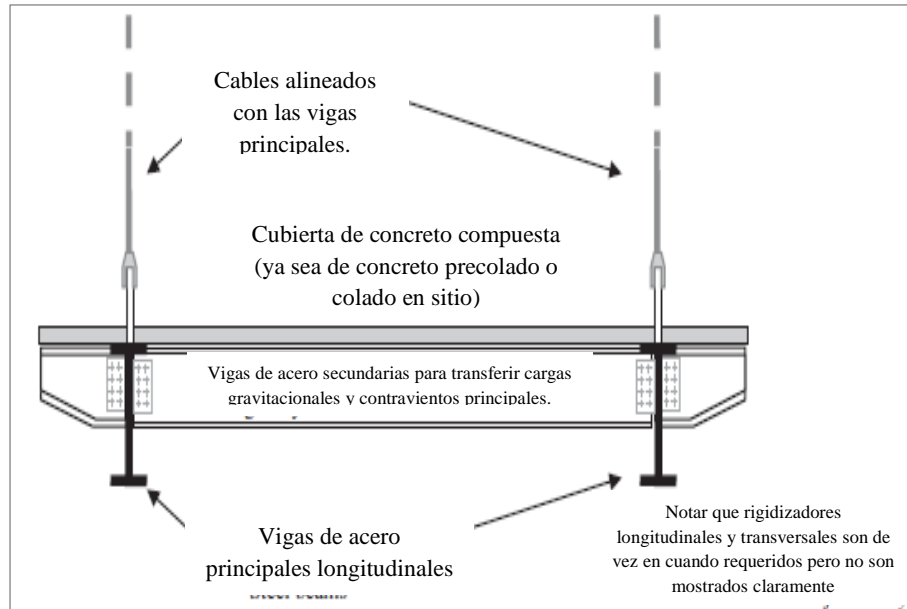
Típica cubierta de sección compuesta de puentes atirantados (Calvi, Sullivan, & Villani, Conceptual seismic design of cable-stayed bridges, 2010).
